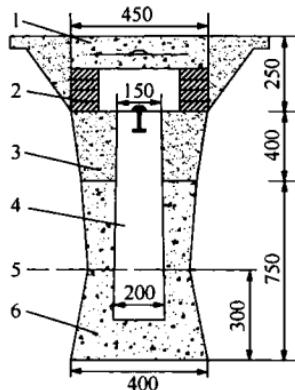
混凝土水准点标石埋设（单位：mm）
